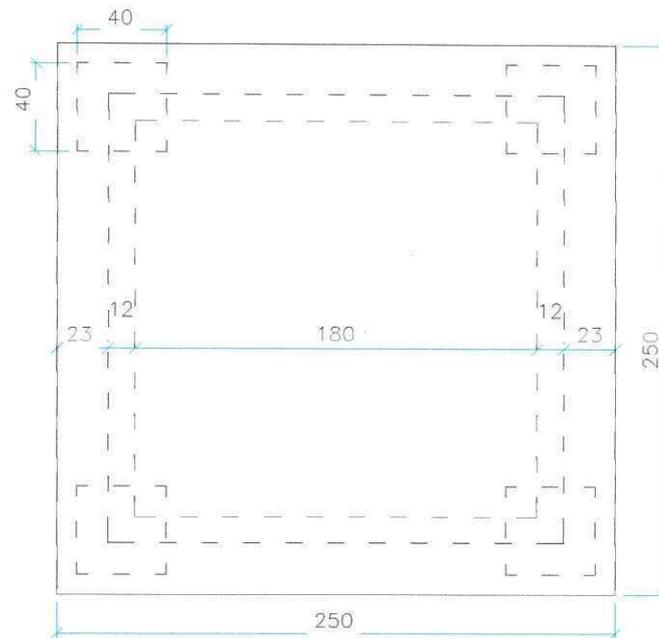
Detalhe da fôrma do pilar do poço do elevador
